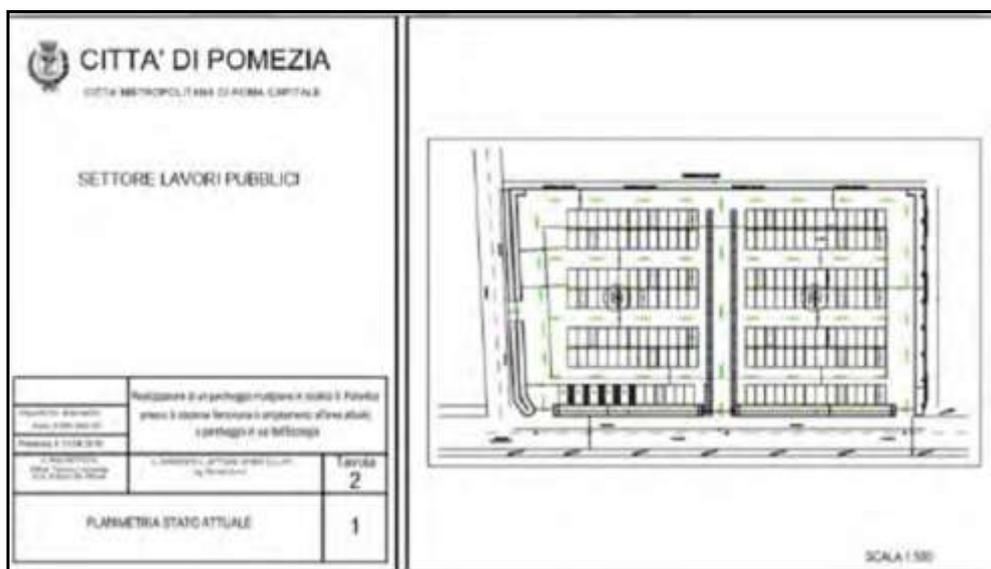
Planimetria del progetto di parcheggio multipiano
